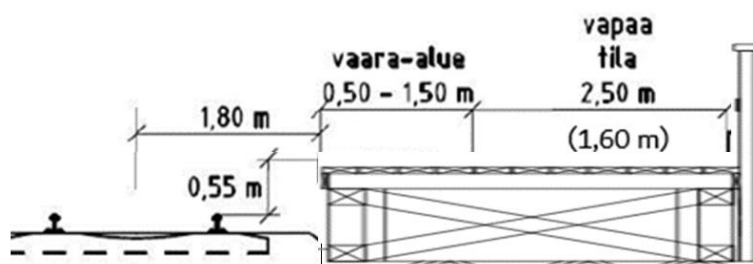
Betonielementtireunainen asfaltoitu tyyppilaituri.
